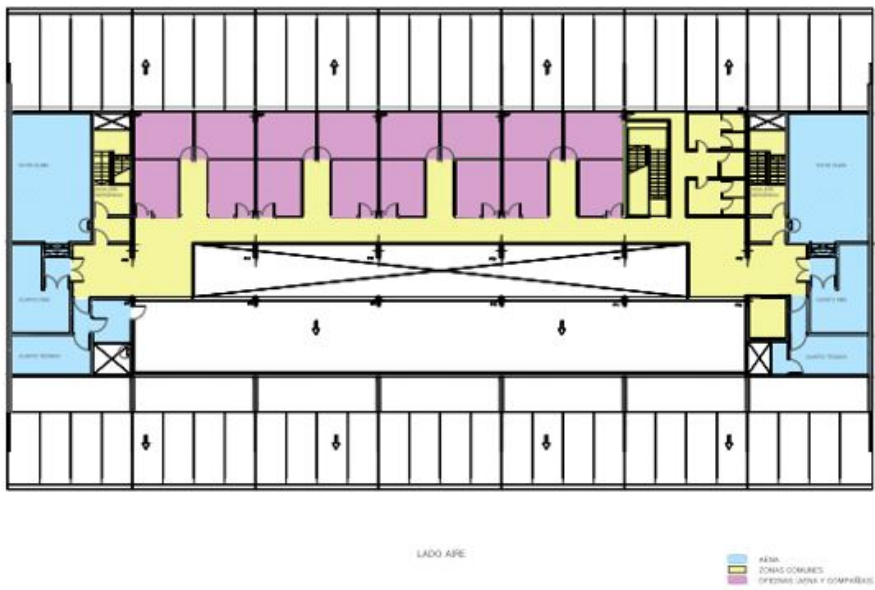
Vista en Planta de los Espacios de la Planta Superior Actual
